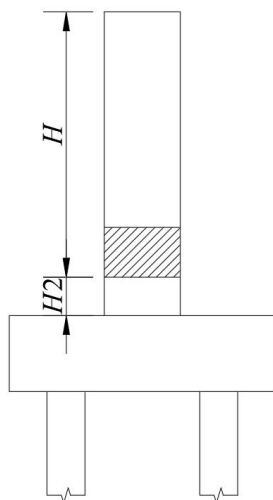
装配式混凝土单柱墩容许位移计算示意图
